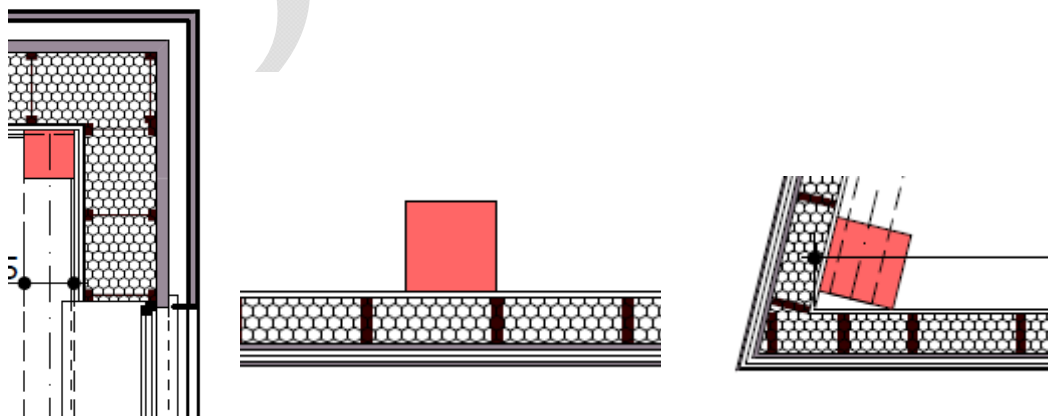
Vue en plan de l'enveloppe autour de la structure du bâtiment REGAIN
